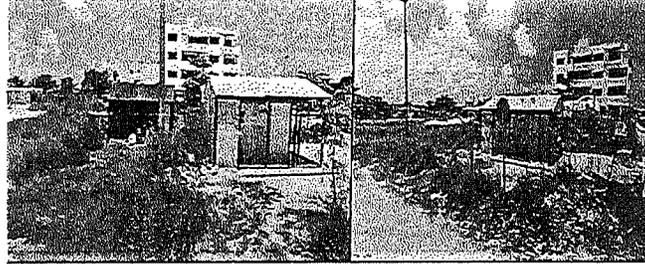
a) Vista lateral de casa 2 de madera y b) Vista lateral de casa 2 de madera ubicada sobre calle huachinango...
